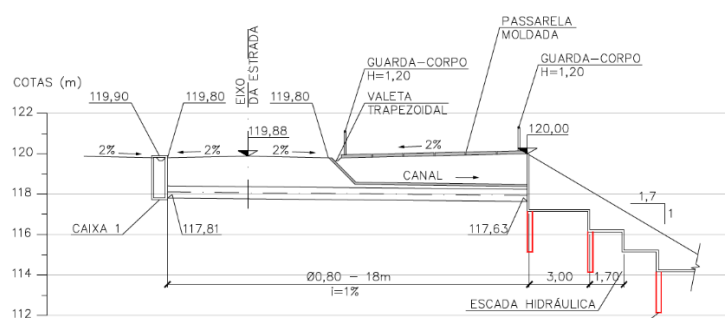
Secção longitudinal da via rodoviária, projeto de execução (BDM, 2017)
